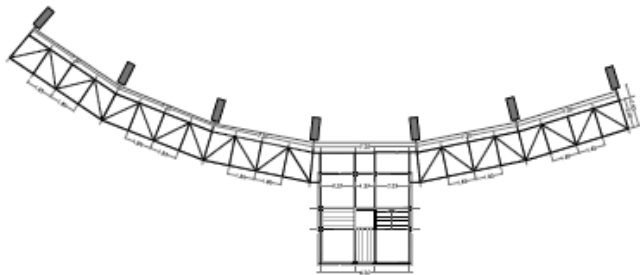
Plano de Unión Pasarela Metálica con Escaleras Metálicas.
